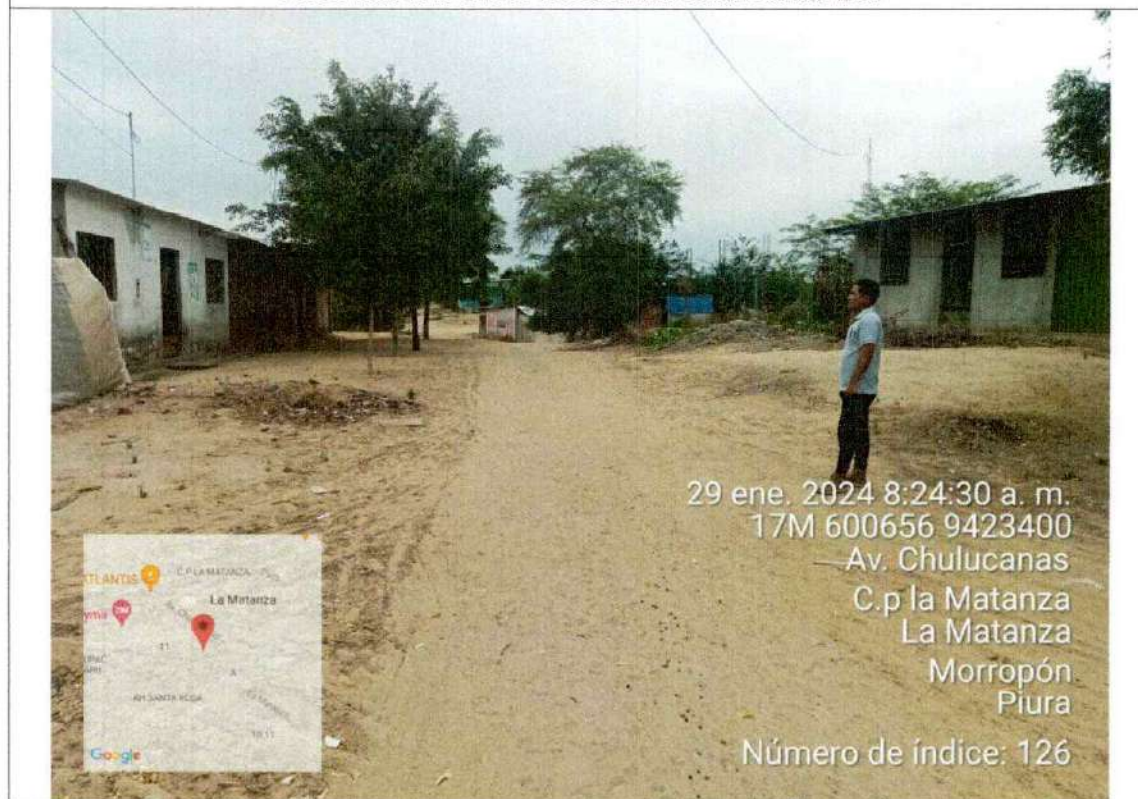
Vista de la calle Santa Rosa del A.H. Santa Rosa
